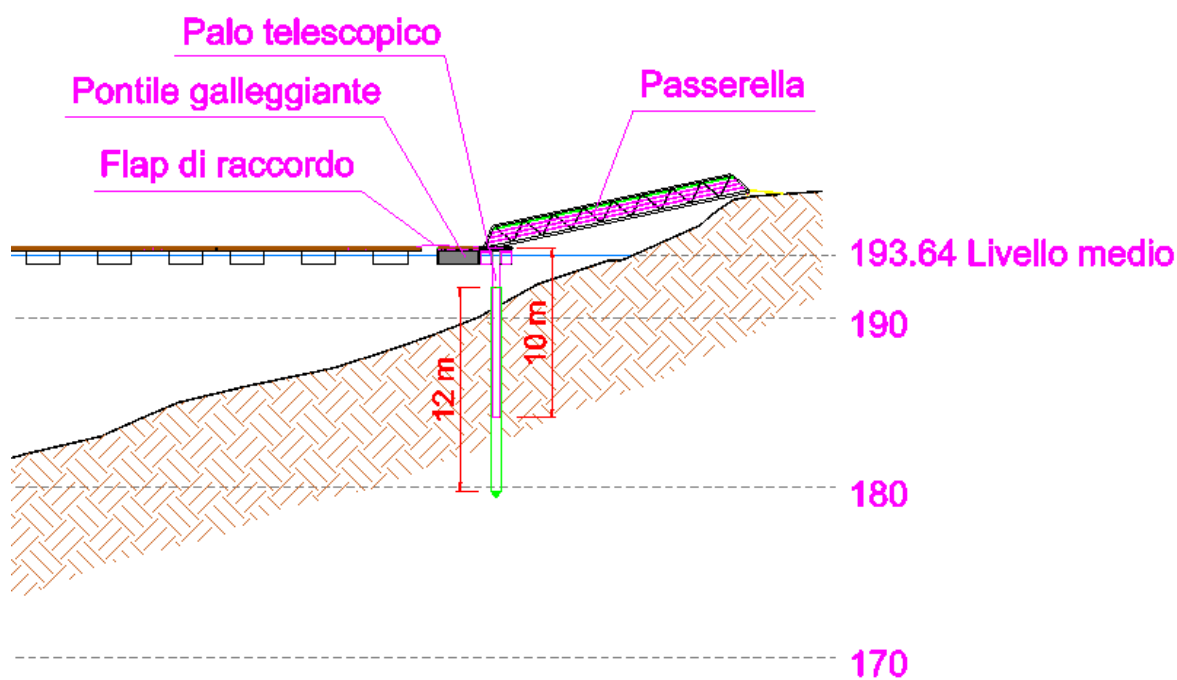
Sezione del pontile di riva, pali telescopici e passerella
